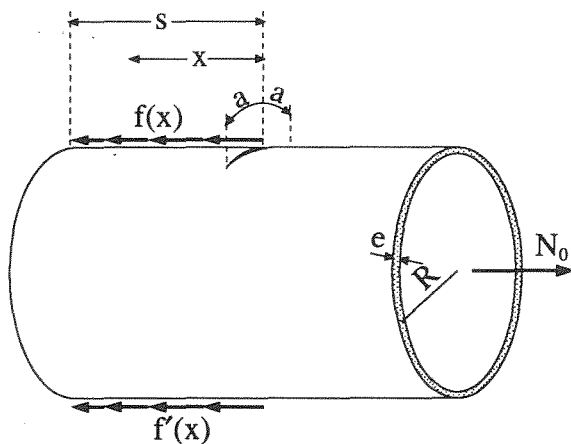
Cargas y fisura en el detalle constructivo.
